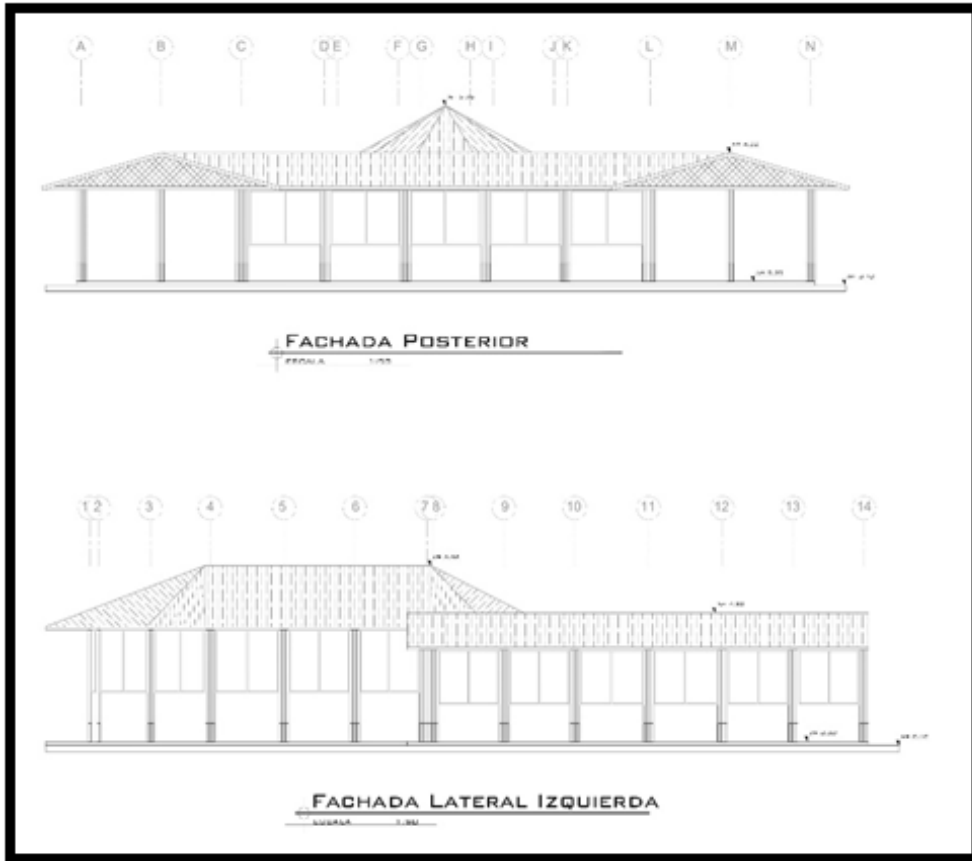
Fachada Posterior y Fachada Lateral Izquierda
